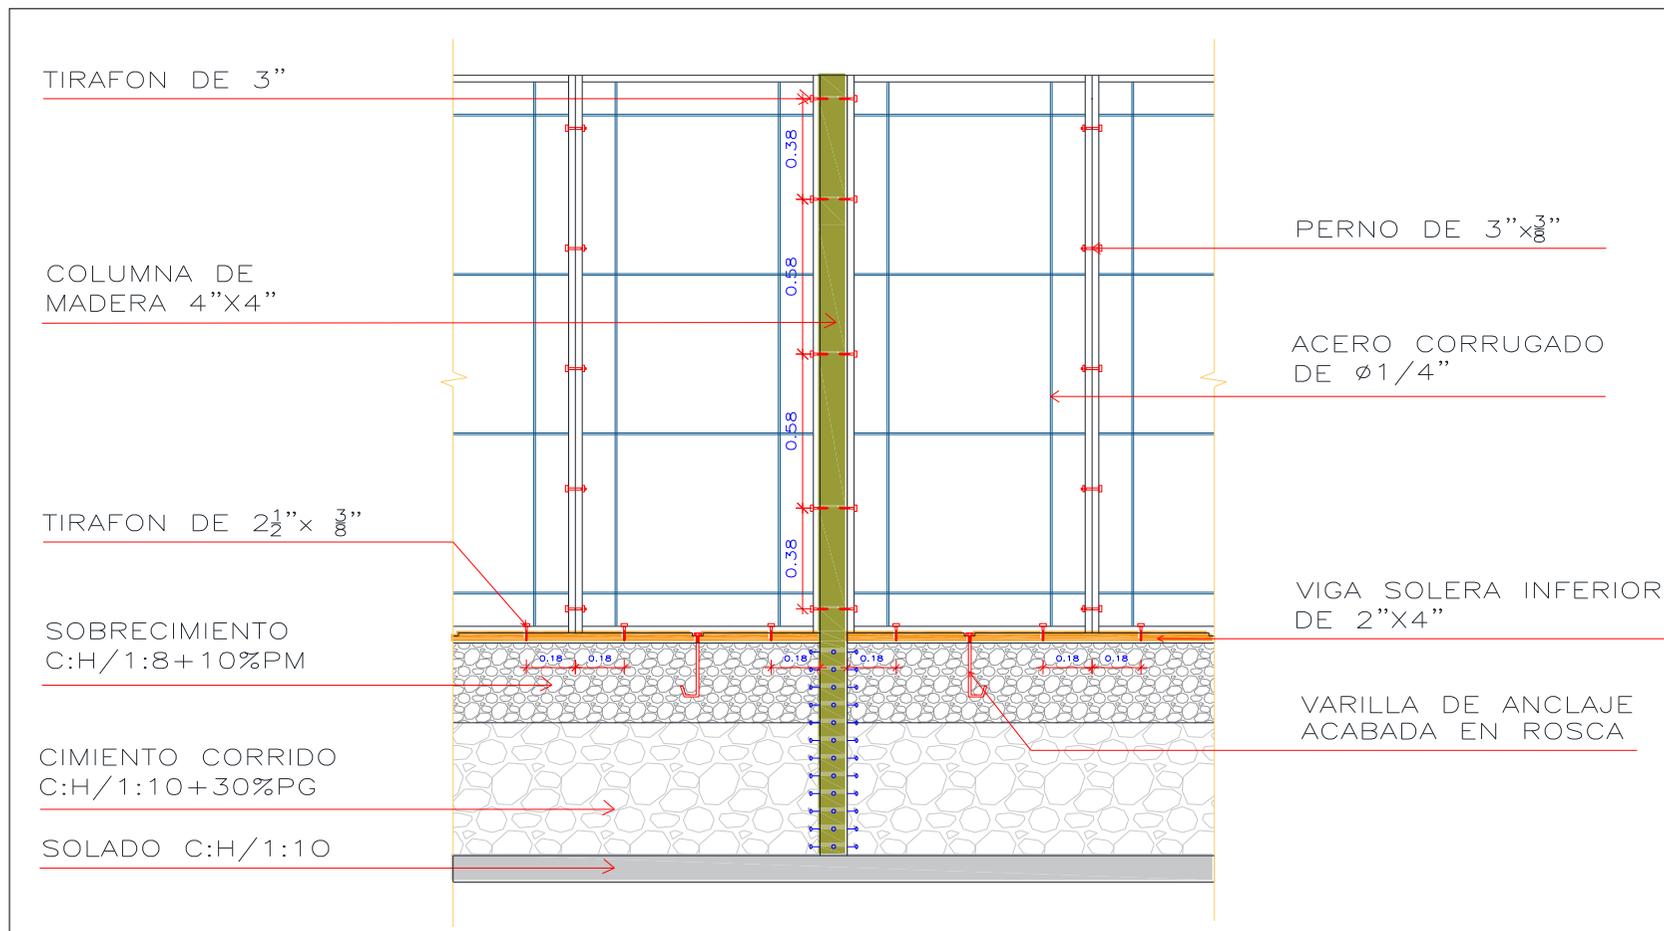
Fijación de paneles muro entre sí, a viga solera inferior, columna, y cimentación
